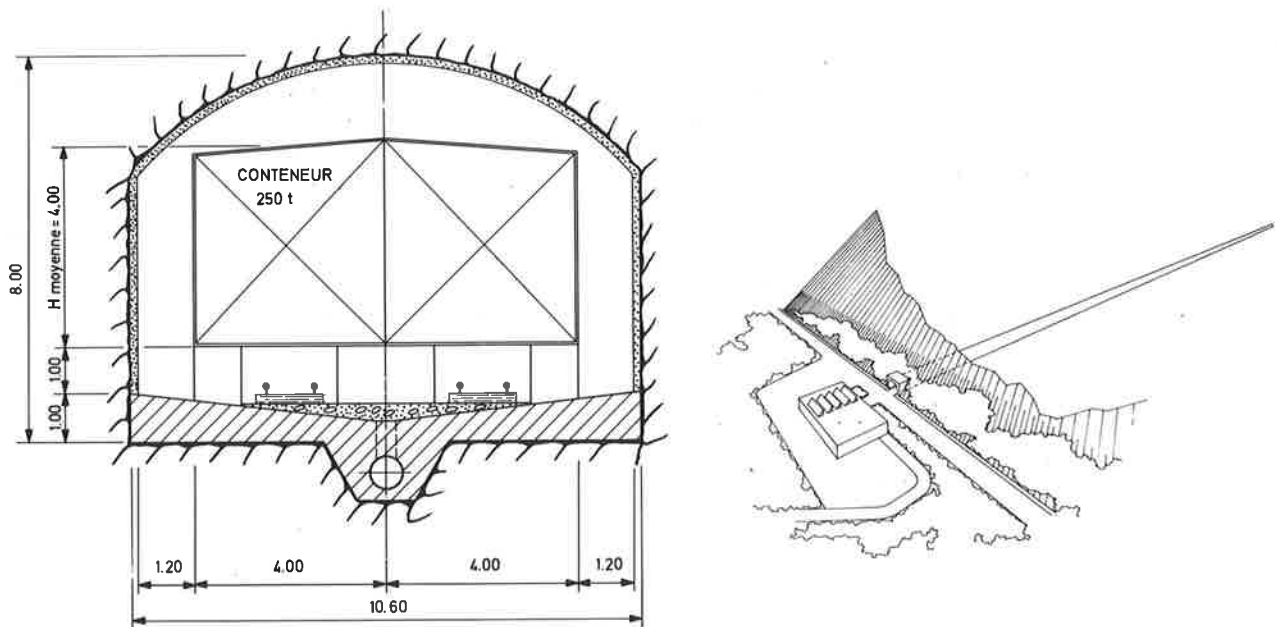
VARIANTE 7 / Coupe transversale et ensemble
